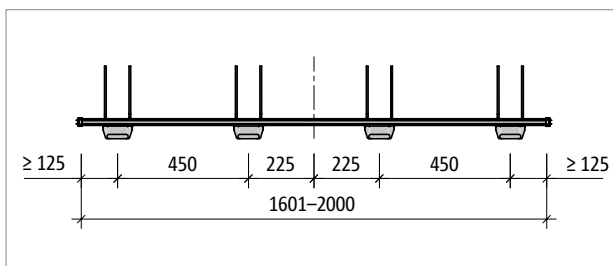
Schöck Tronsole® typ T-V4...-L700 až L1000: Půdorys prvku
